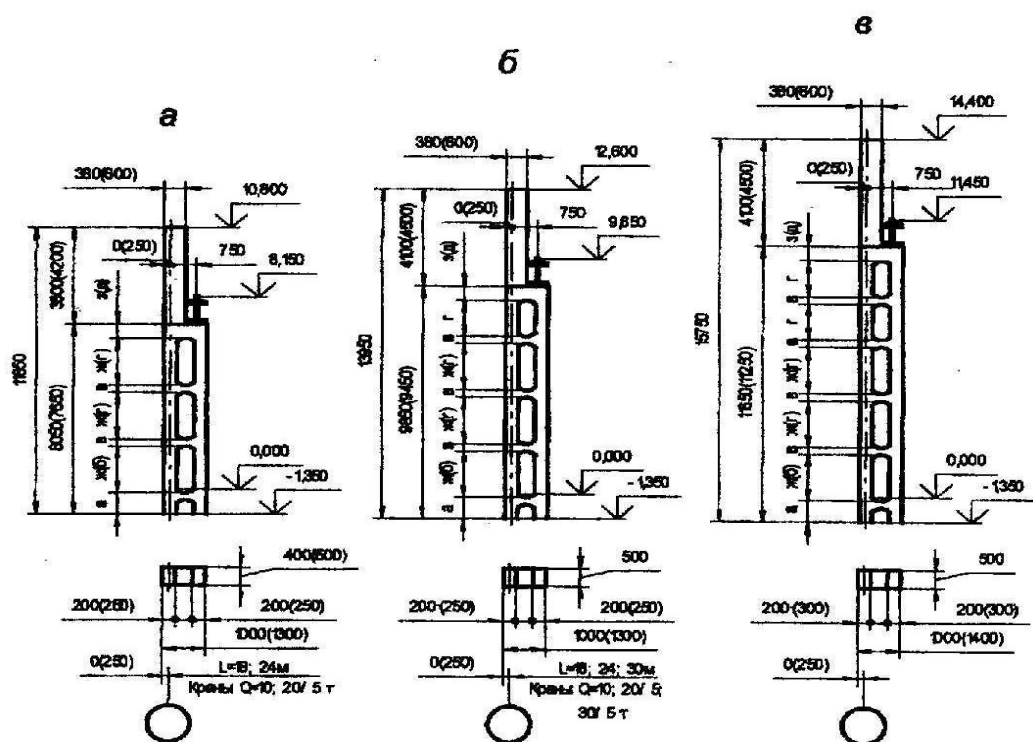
Габаритные размеры железобетонных колонн, мм, среднего ряда:
